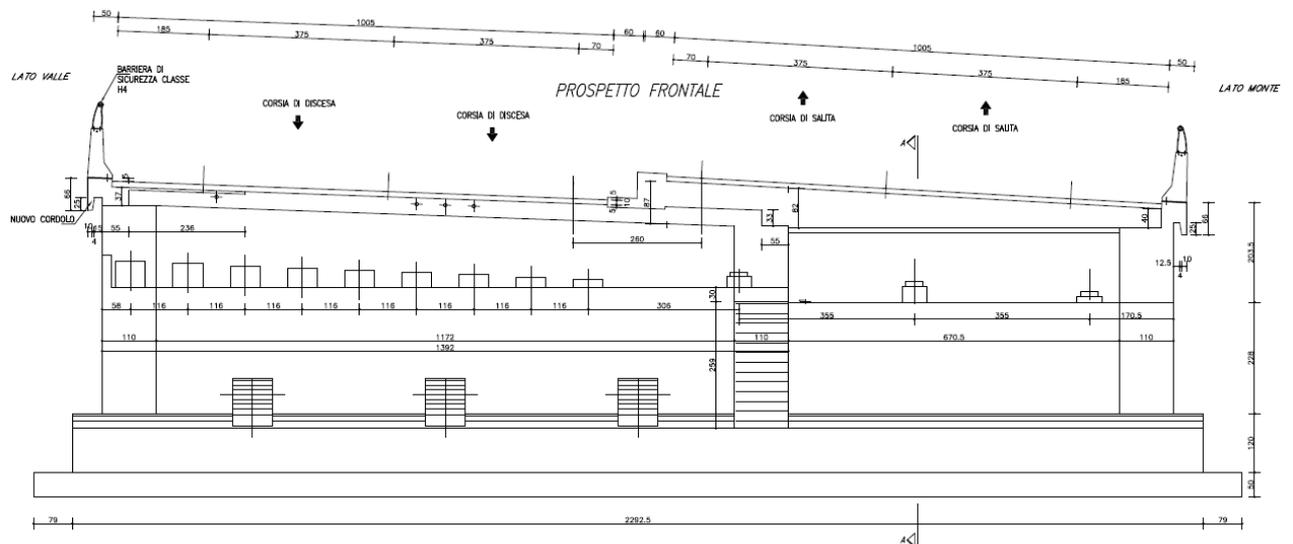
Prospetto frontale spalla lato Bardonecchia
